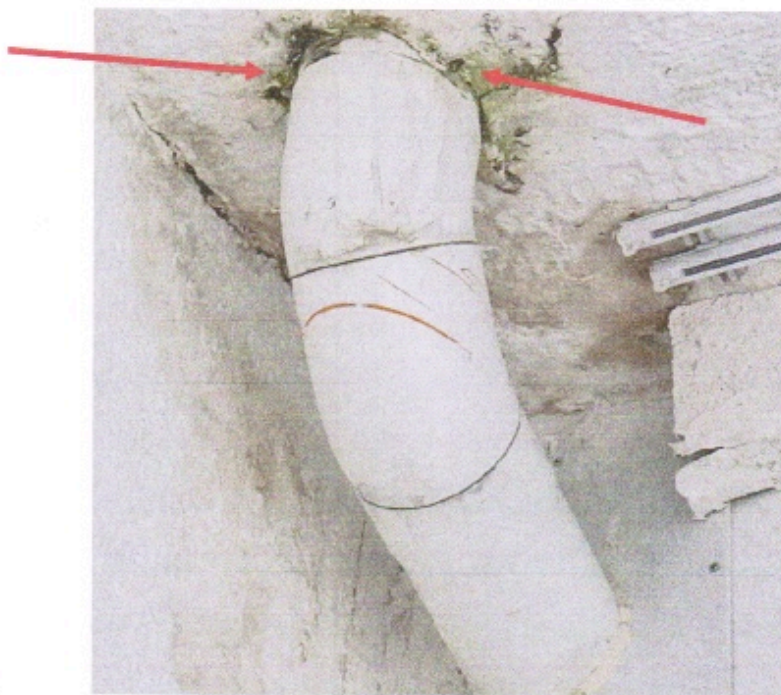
Следы многократных намоканий с образованием мха сверху на перекрытии балкона, на стене и непосредственно на трубе.
